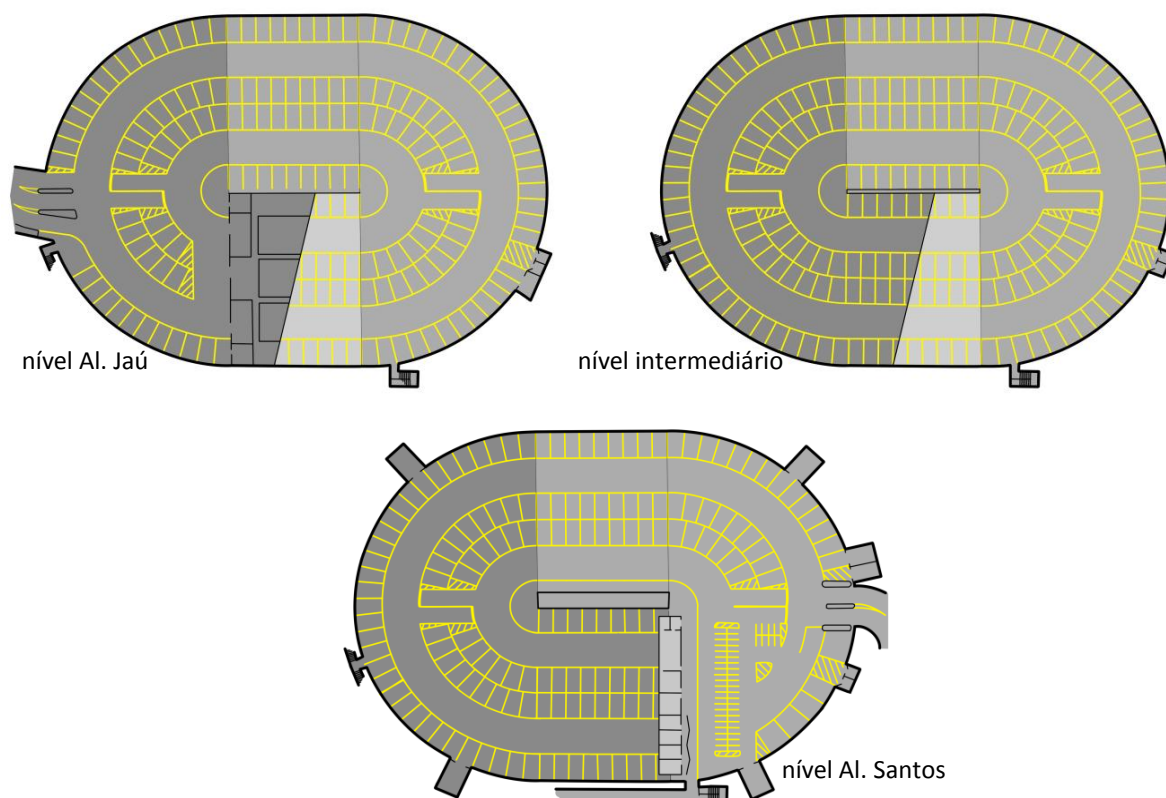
Plantas dos três pavimentos da garagem Trianon (sem escala) – Anexo 8
